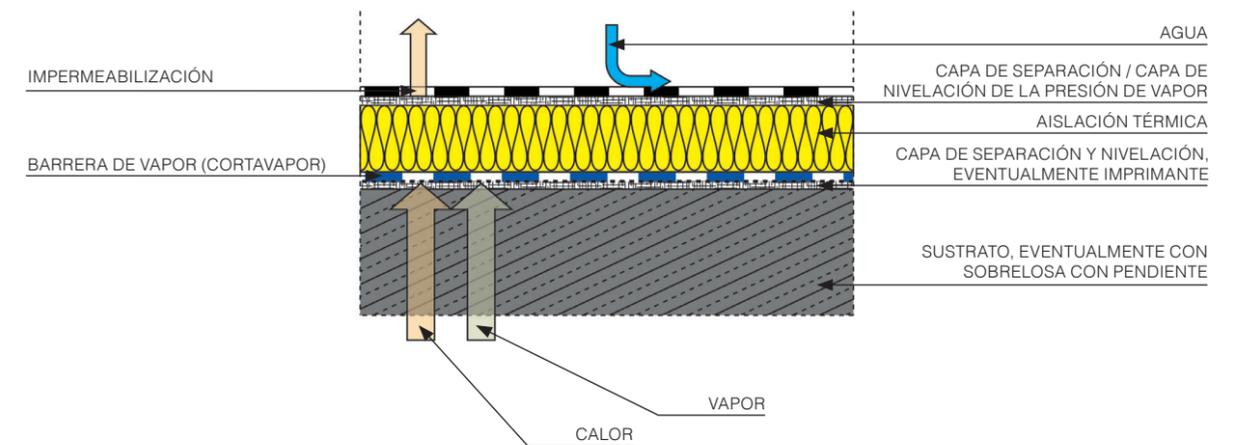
Esquema básico de tipología de cubierta plana “techo caliente con impermeabilización expuesta”. Fuente: www.ing-büro-junge.de/html/flachdach.html, traducido y modificado.
